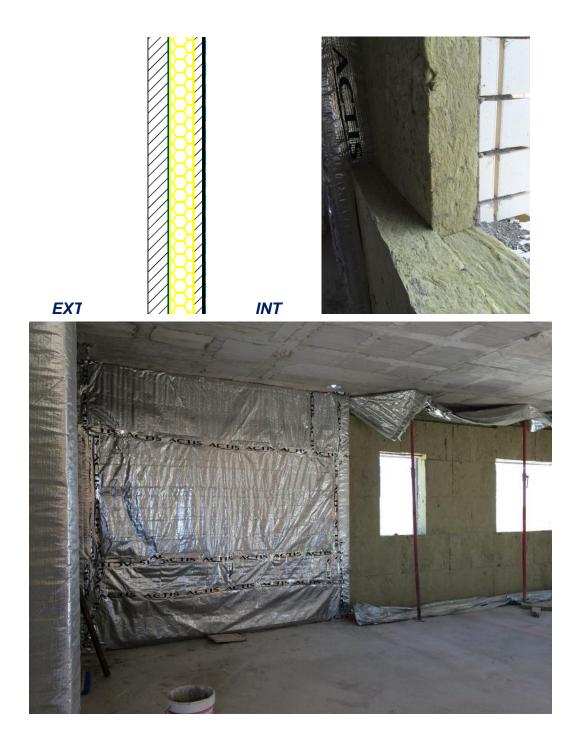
izda.: Detalle de las capas ejecutadas en la vivienda.
